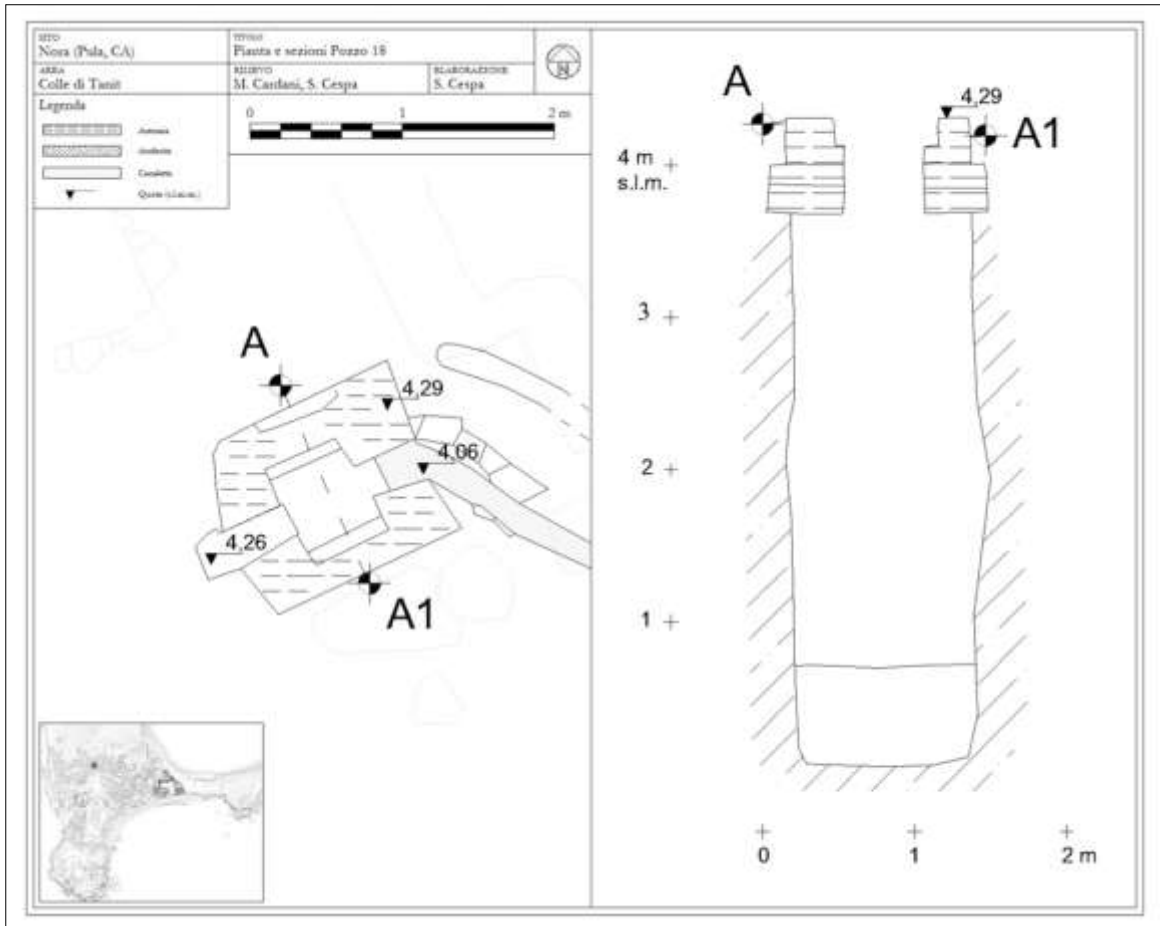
Pianta e sezione del pozzo 18 (elaborazione dell'autore).
